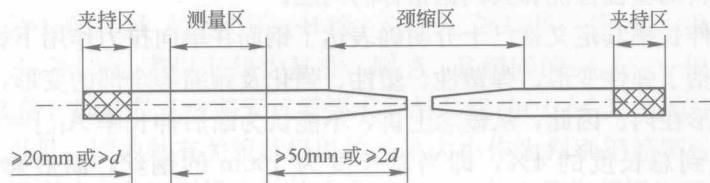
钢筋断裂后测量 $A_{gt}$ 示意
